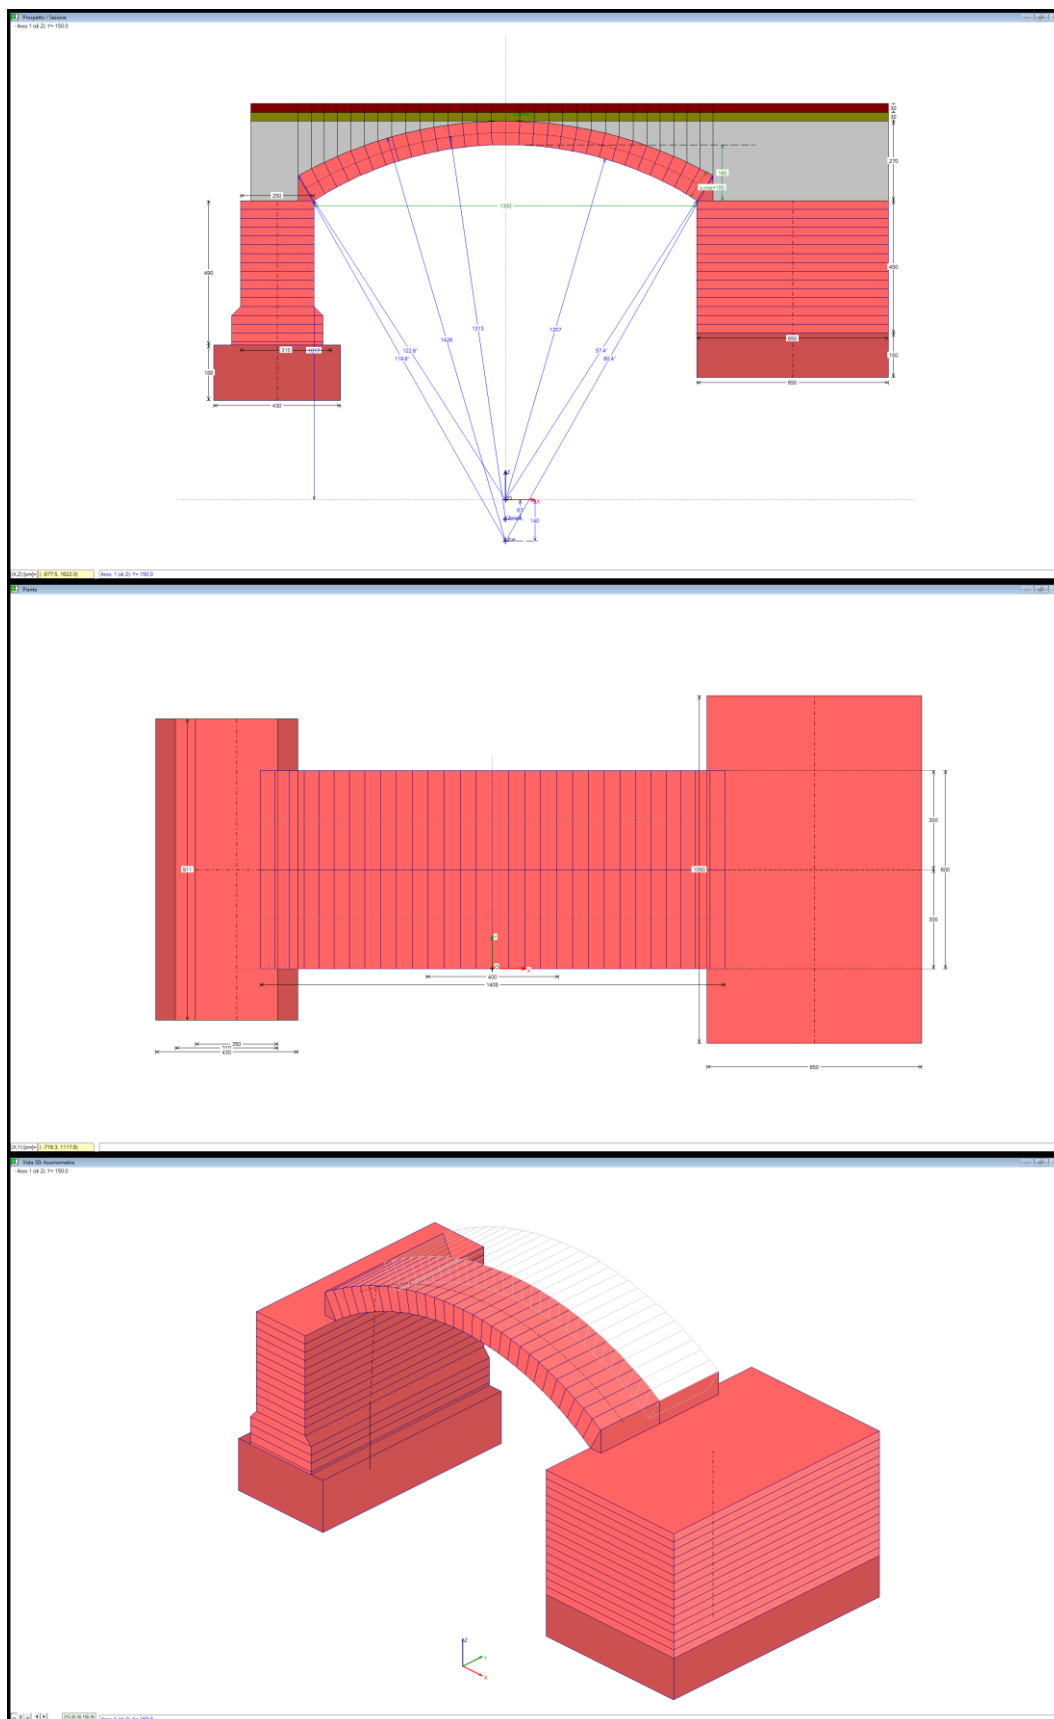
Modelli Ponte-Lanzo-R0\_DX-Fase1 e Ponte-Lanzo-R0\_DX-Fase2 – Prospetto, pianta e assonometria (dall'alto in basso)
